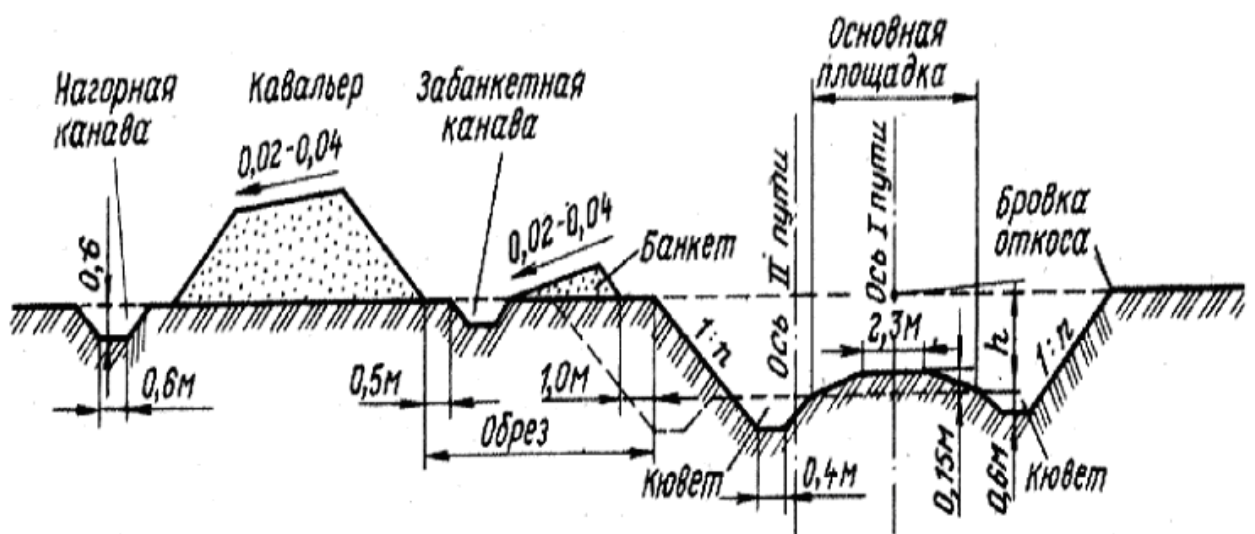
Типовой поперечный профиль выемки, 1-полоса отвода; 2-нагорная канава; 3-кавальер; 4-забанкетная канава; 5-банкет; 6-кювет; 7-балластный слой; 8-обочина
